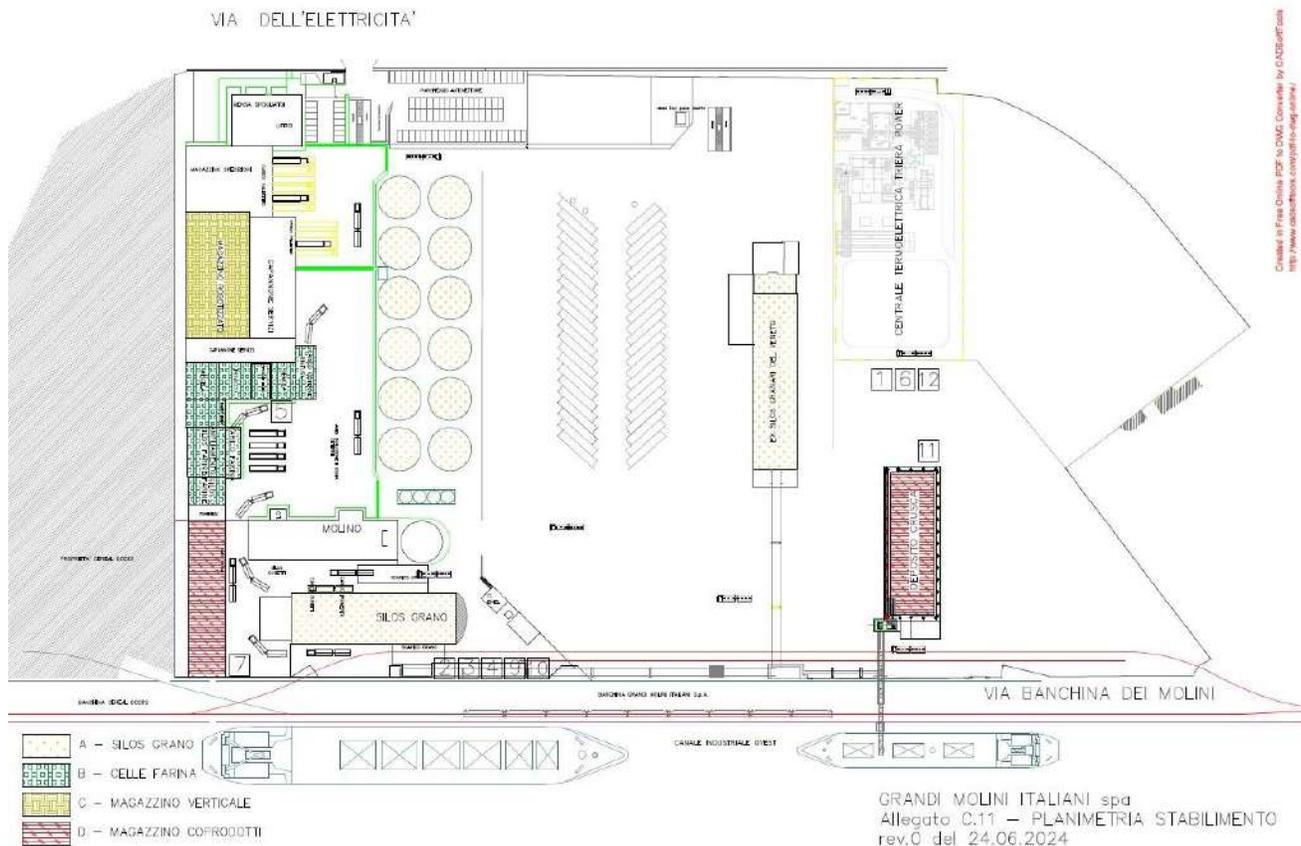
Estratto planimetria C11 – Stoccaggi di progetto
